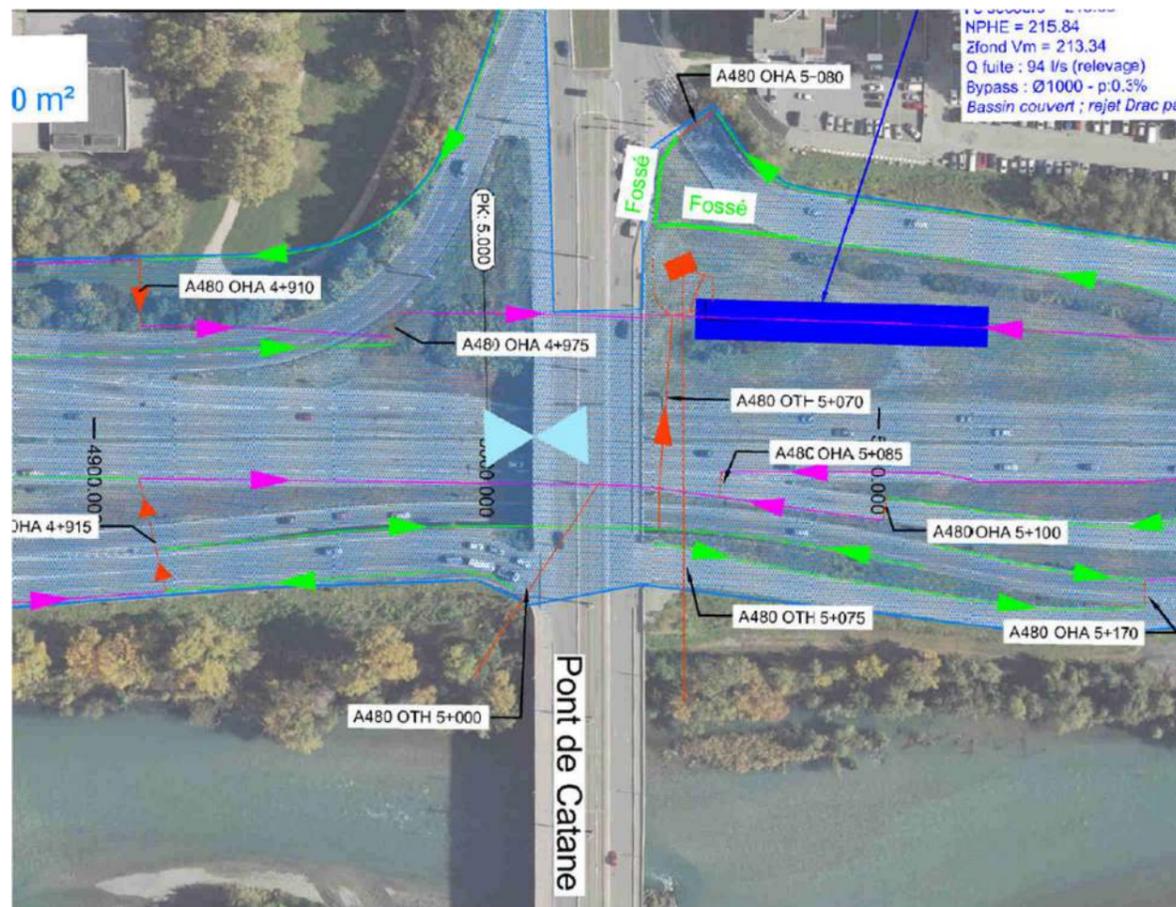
Zoom sur le dispositif d'assainissement au droit de Catane : OTH 5+000
